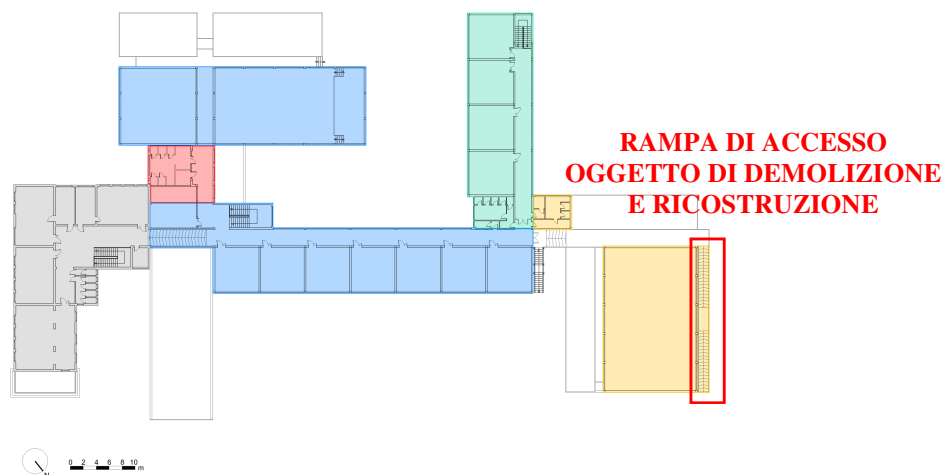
Zona di realizzazione del nuovo parapetto per la rampa di accesso alla palestra
